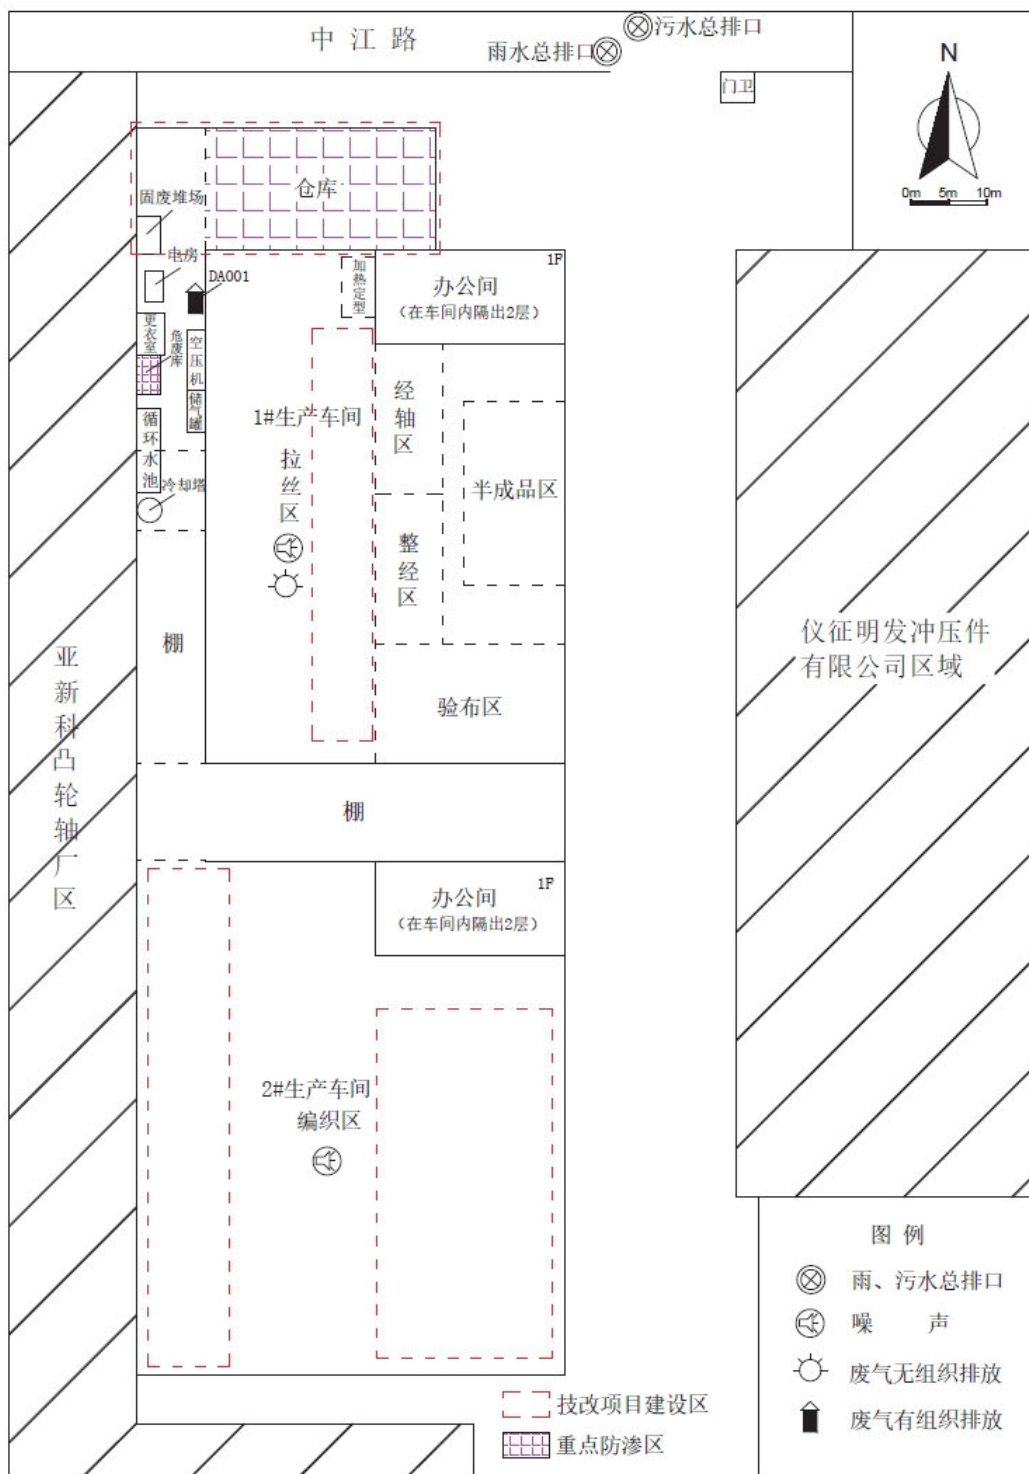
厂区总平面布置图（与环评中图基本一致）
